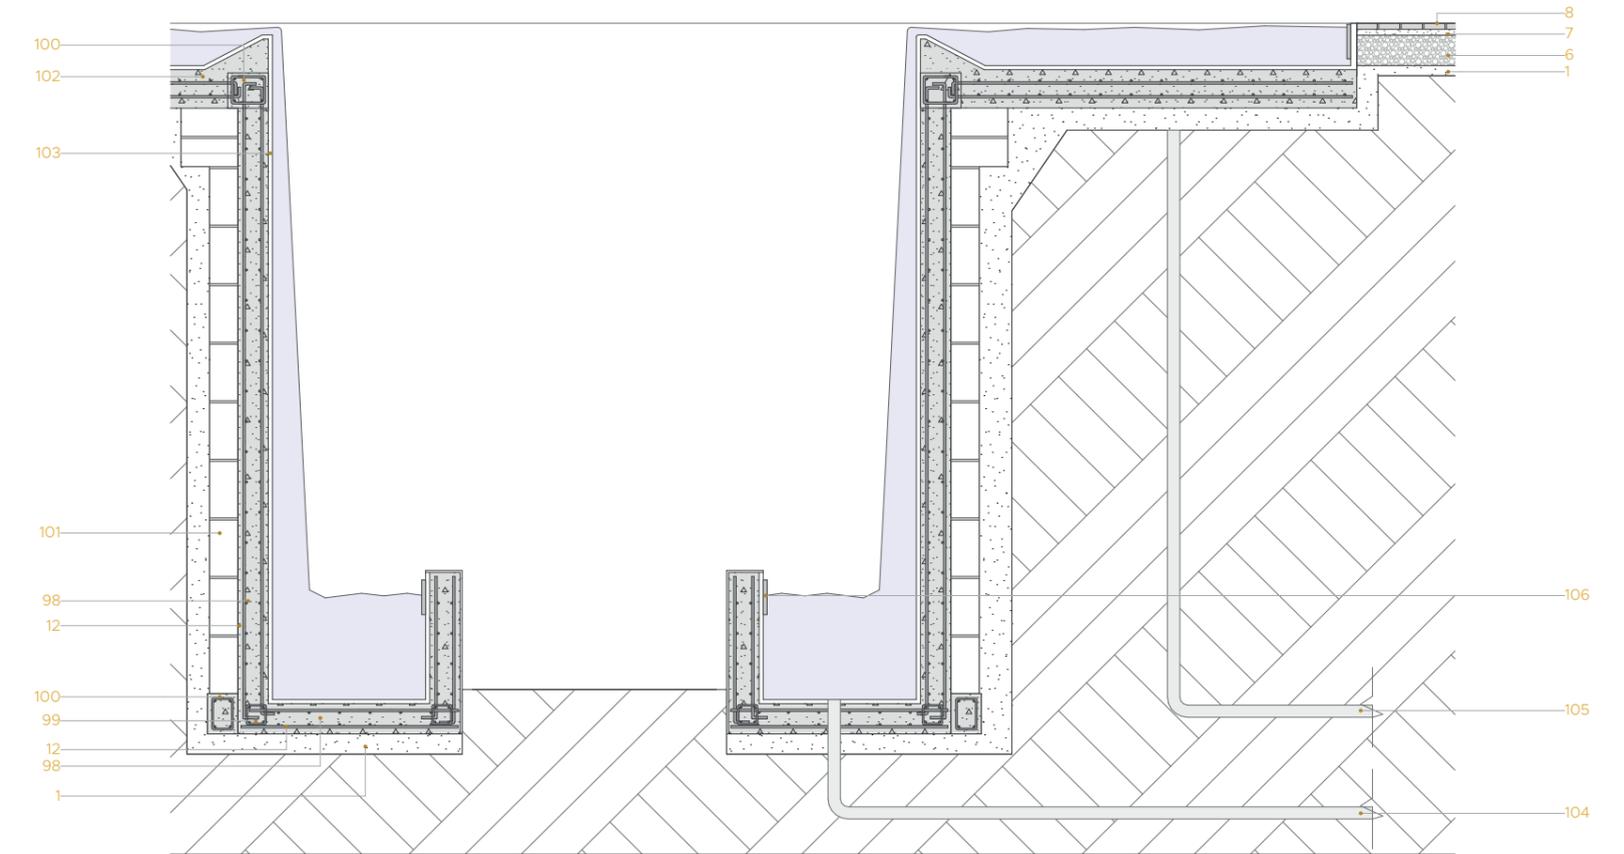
\_C4: sección constructiva\_18, cascada, memorial
